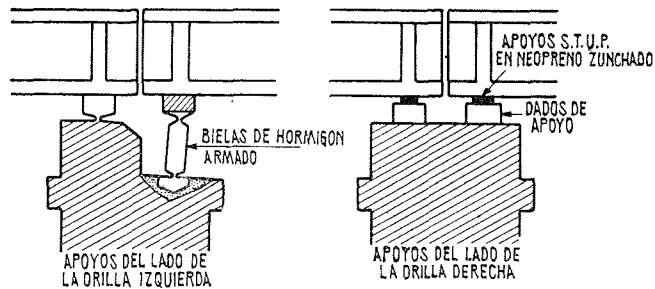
Apoyos del puente sobre el Wouri, en Douala (Camerón).
